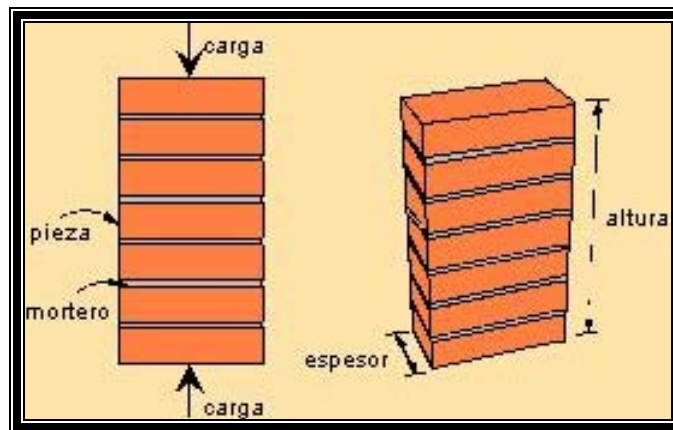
Pilas de piezas sobrepuestas de mampostería para ensaye a compresión
